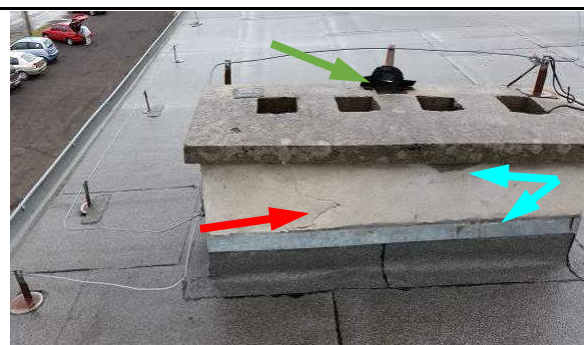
Widok powierzchni dachu pokrytej papą termozgrzewalną.
